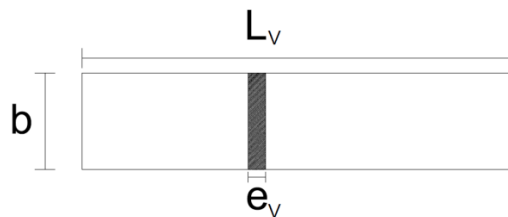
Agrietamiento debido a flexión en una viga, vista inferior.
